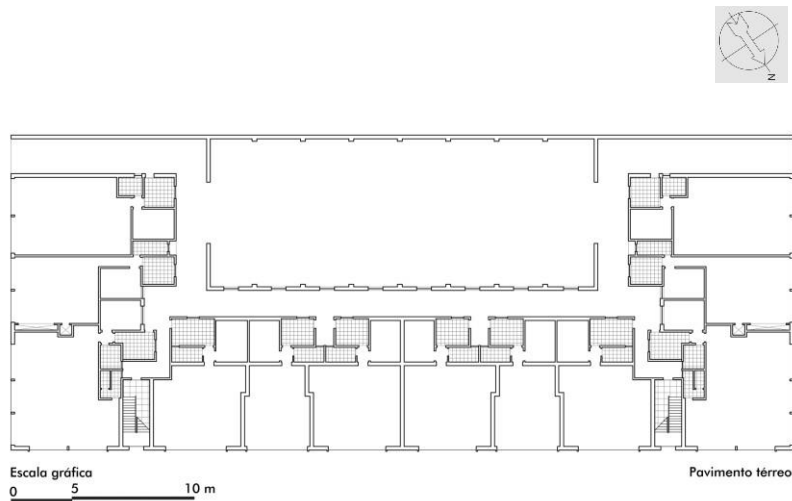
Planta baixa pavimento térreo. Desenho baseado nas plantas arquivadas no processo de Registro de Imóveis de Osório.
